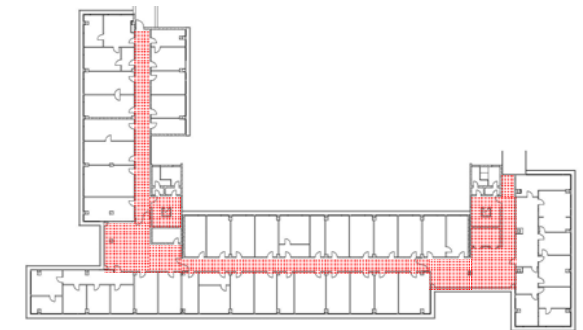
Regelgeschoss - Grundriss 2.OG
